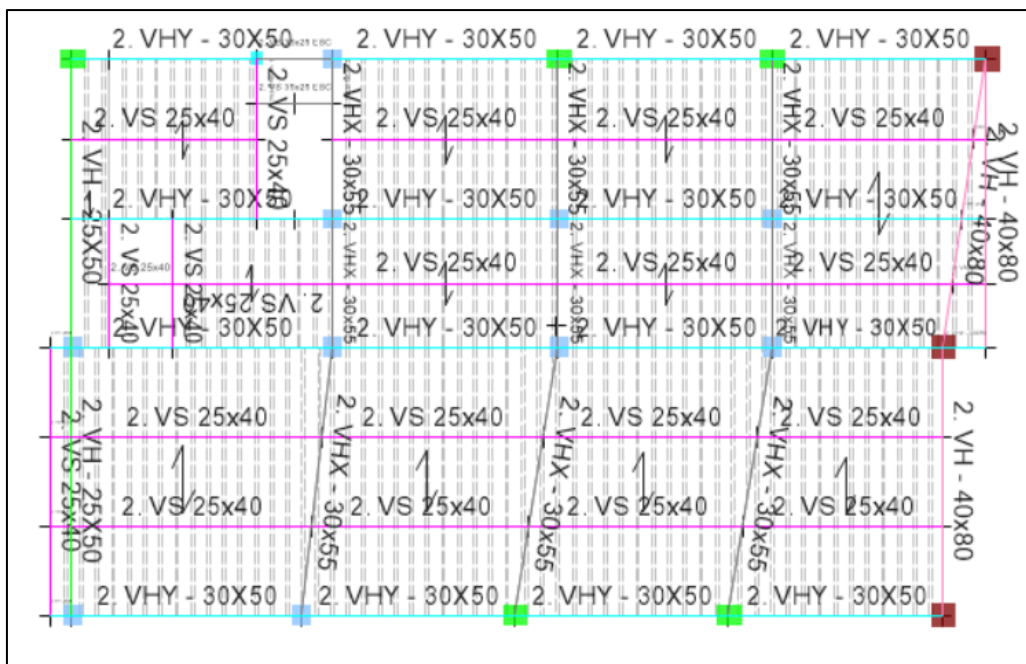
Planta tipo P2 a Cubierta, N.E. +7.20 m a 14.40 m (Castillo & Peñaloza, 2022)
